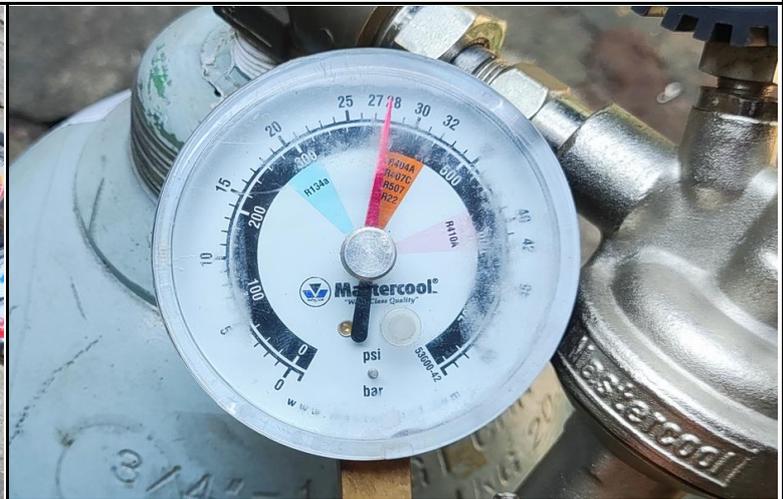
APLICAÇÃO DE 400 PSI PARA EXECUÇÃO DO TESTE.
